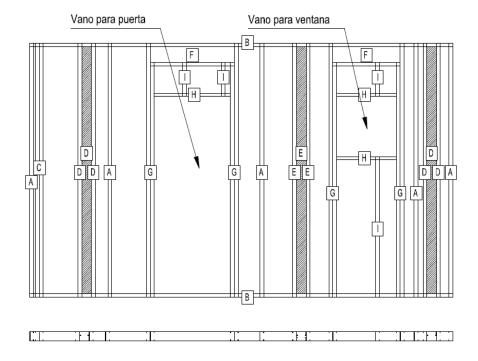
Vista de un Panel Steel Framing. Fuente: (ConsulSteel, 2014).
